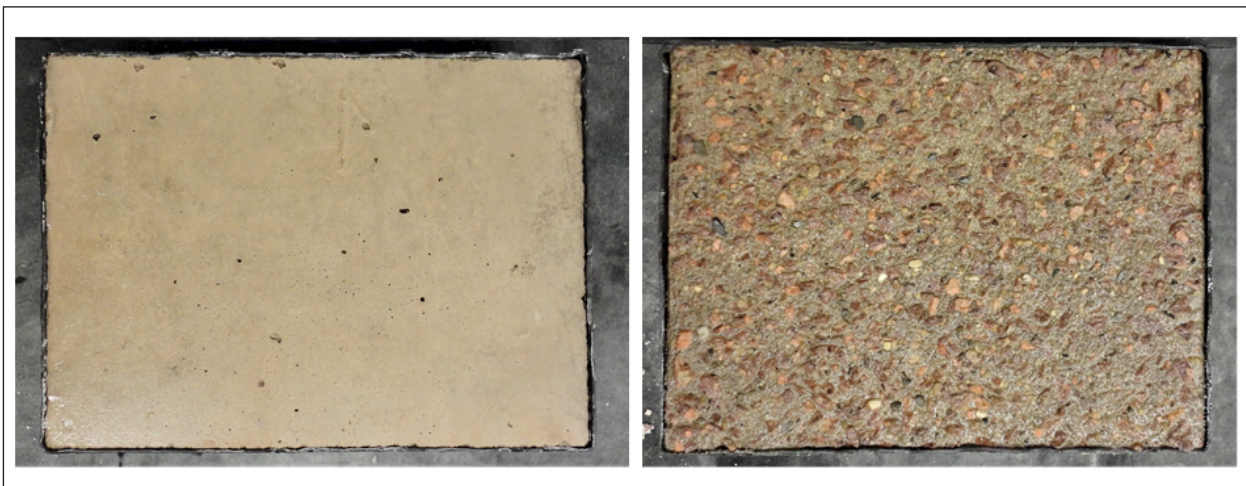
Prüfflächen der Prüfkörper für die CDF-Prüfung; an Teflonschalung anbetonierte Prüffläche (Ober- und Unterbetone) (links); Waschbetonoberfläche (Waschbetone) (rechts)
